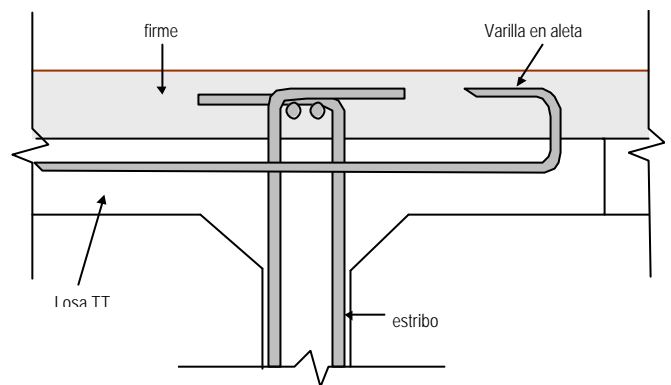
Estribos y varillas de aleta como conectores entre la trabe y el firme o losa
